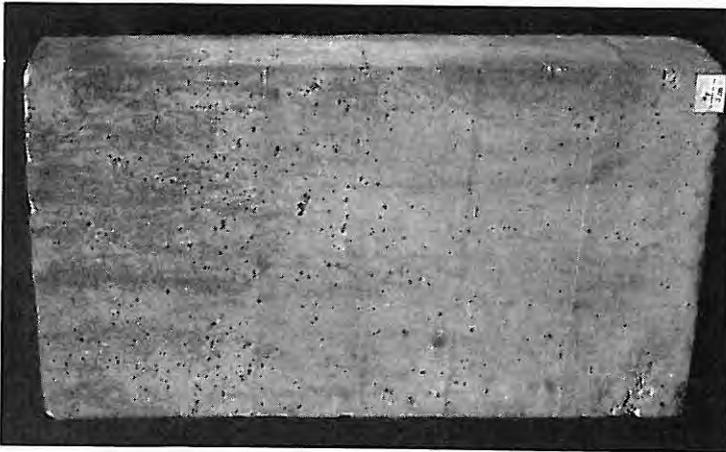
Beschaffenheit einer Betonplatte 70 · 40 · 15 cm aus Beton mit 200 kg Zement je m³ vor dem Auslagern (Platte a1 mit „sandiger“ Fläche im oberen Teil)
